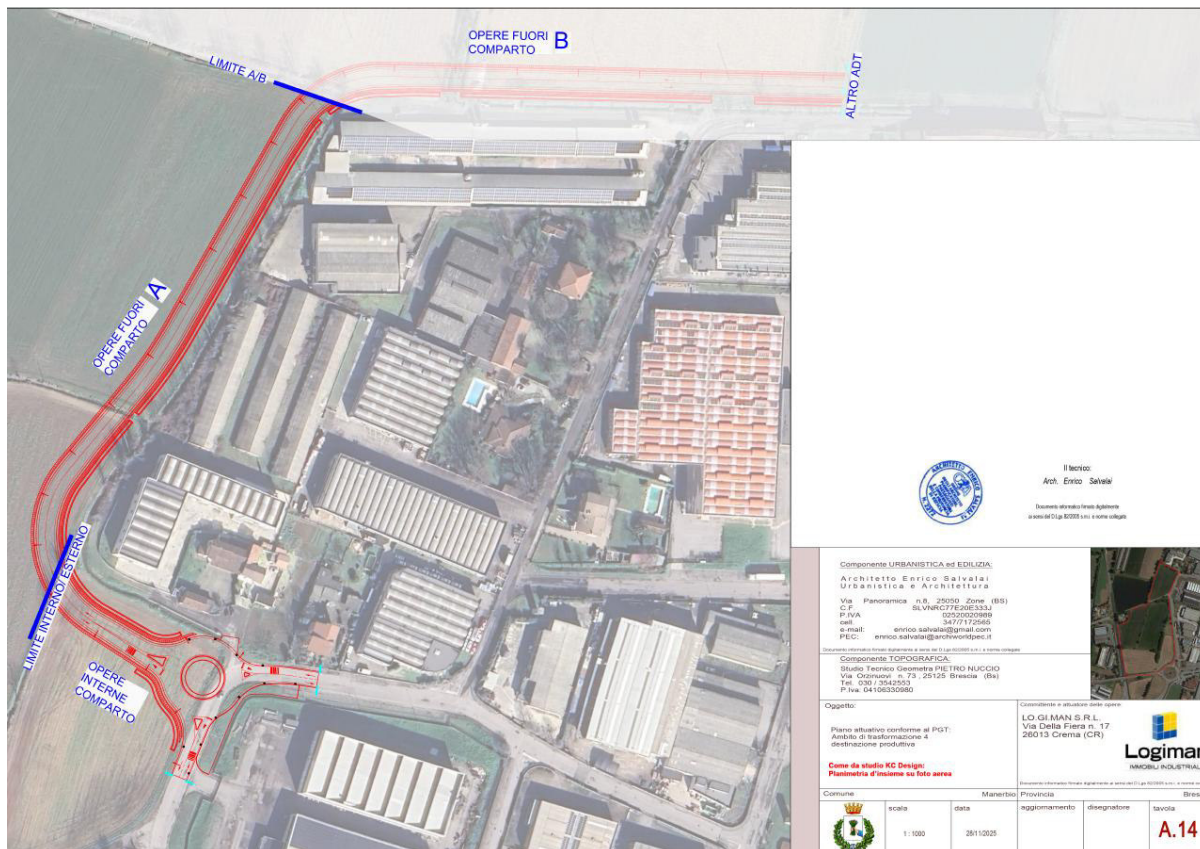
Estratto tavola A.14 Planimetria d'insieme su foto aerea della viabilità fuori comparto
